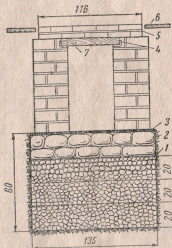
Сплошной фундамент на подушке из разного камня и щебенки с проливкой раствором:
